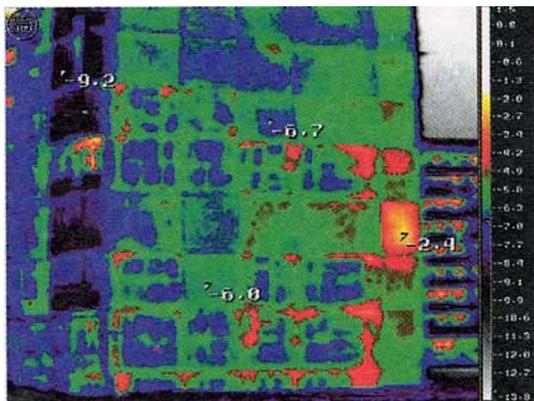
Термограмма стены жилого дома с нарушенной теплоизоляцией панелей (участки красно-желтого цвета)
